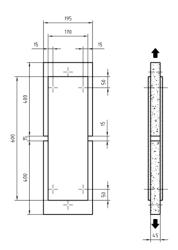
Испытываемый образец для определения прочности обшивки на сдвиг по [8]
